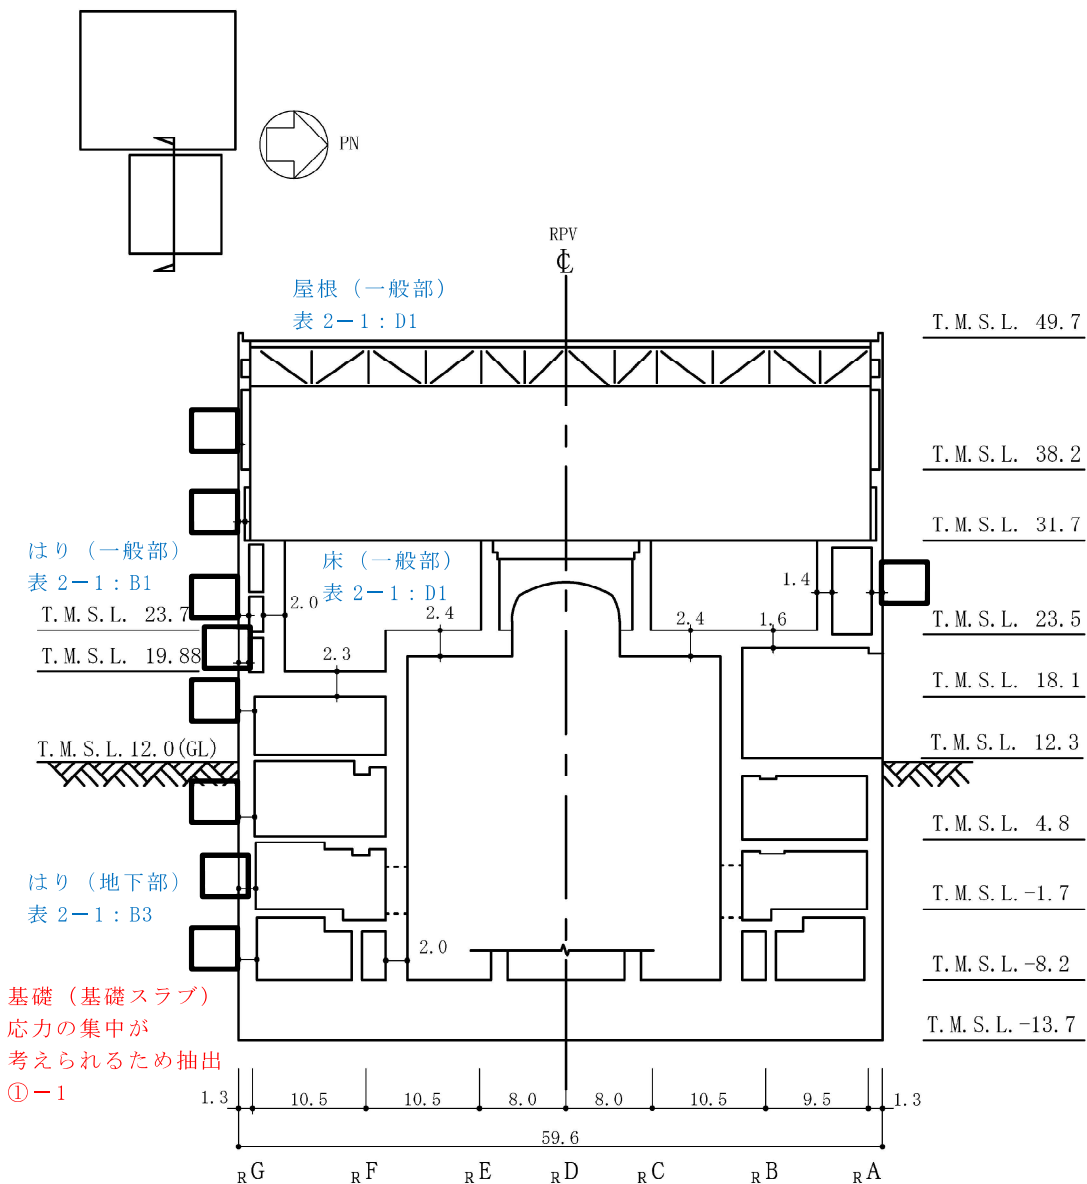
原子炉建屋の概略断面図 (EW 方向) (2/2) (単位: m)
